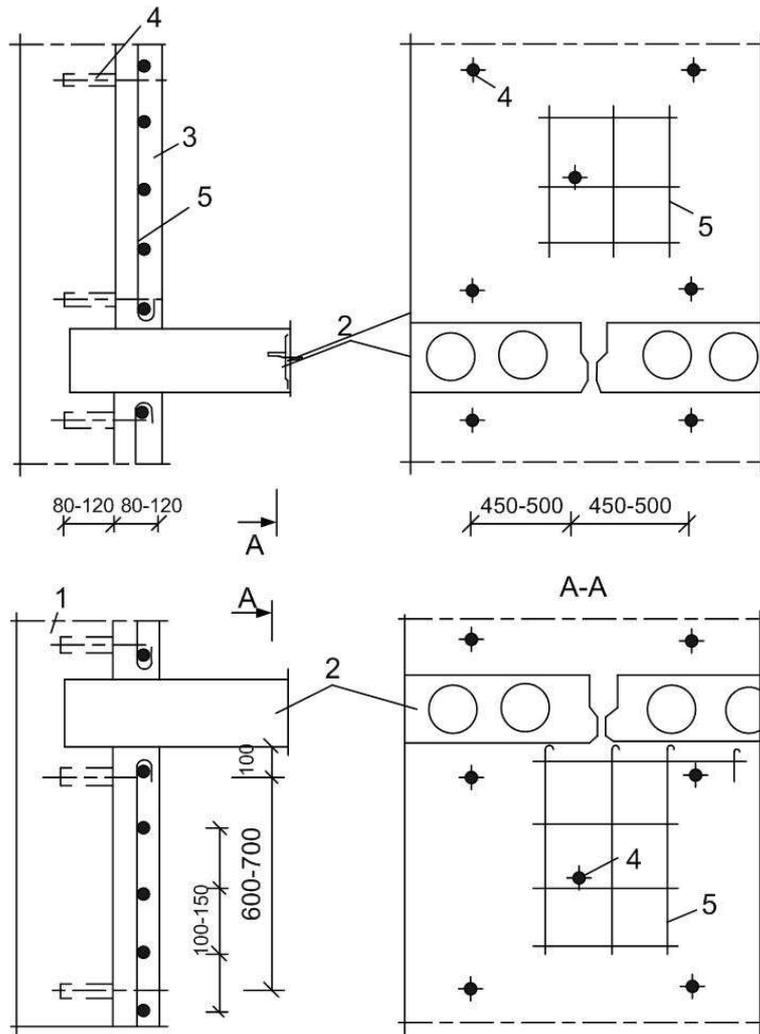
Усиление набетонкой: 1 – усиливаемая стена; 2 – плиты перекрытия; 3 – набетонка; 4 – штыри; 5 – арматурная сетка
